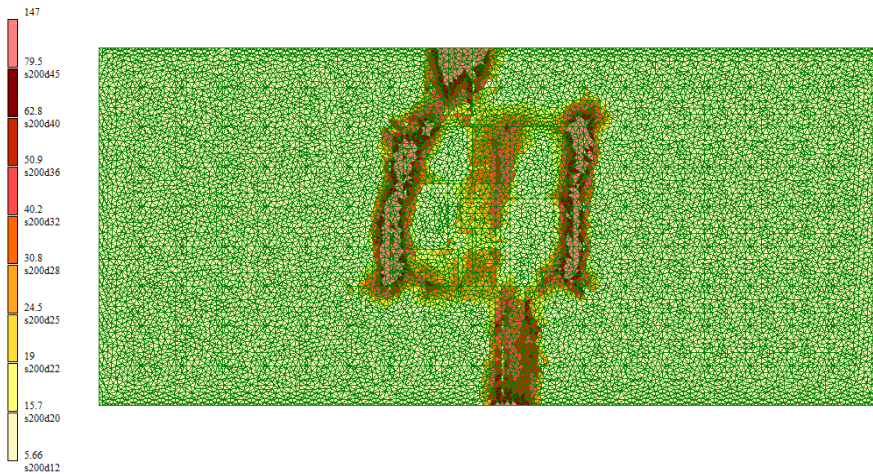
Схема армирования фундаментной плиты по оси X (у нижней грани)
